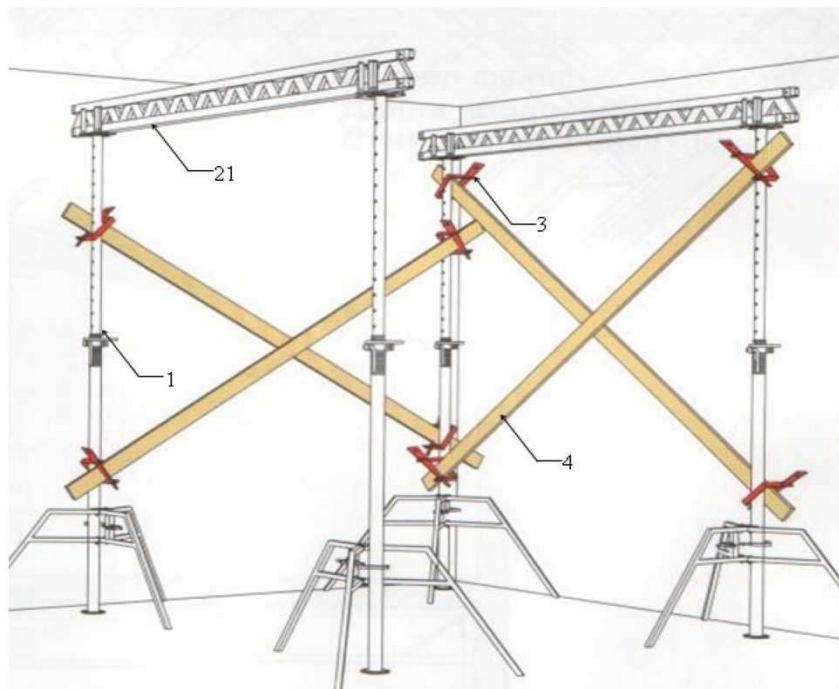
Устройство вертикальных связей: 1-стойка; 2-продольная балка; 3- крепежная скоба; 4-доска
